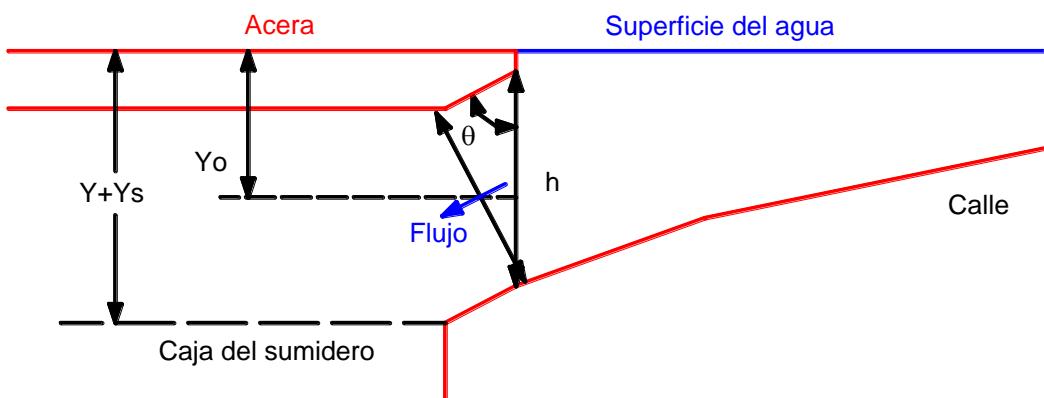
Configuración de la garganta de un sumidero lateral. (8)
